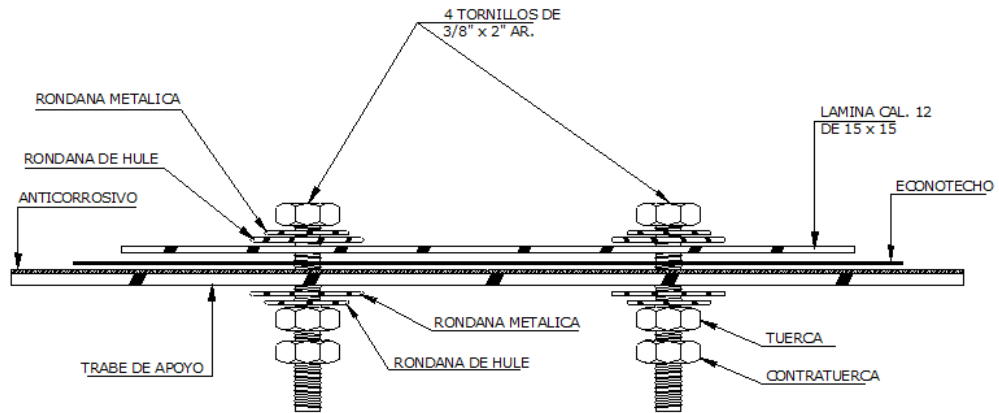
Fijación de la lámina al soporte de apoyo.
